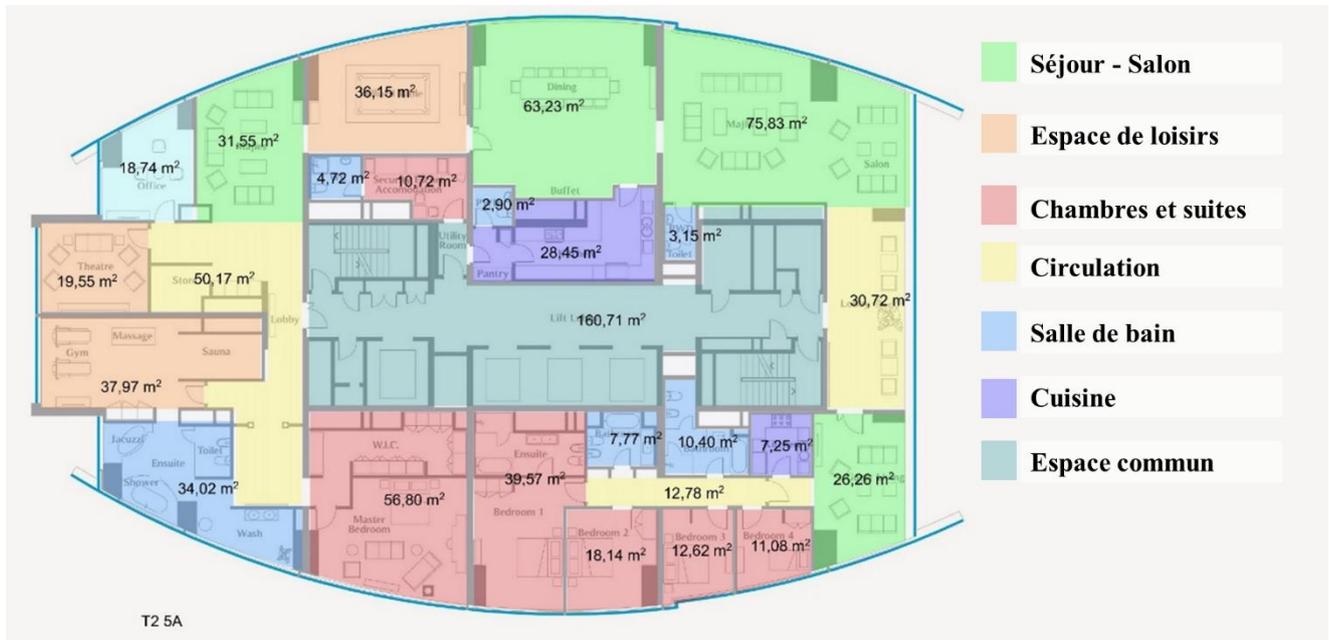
Plan panthouse , Etihad Tower⁹⁷
